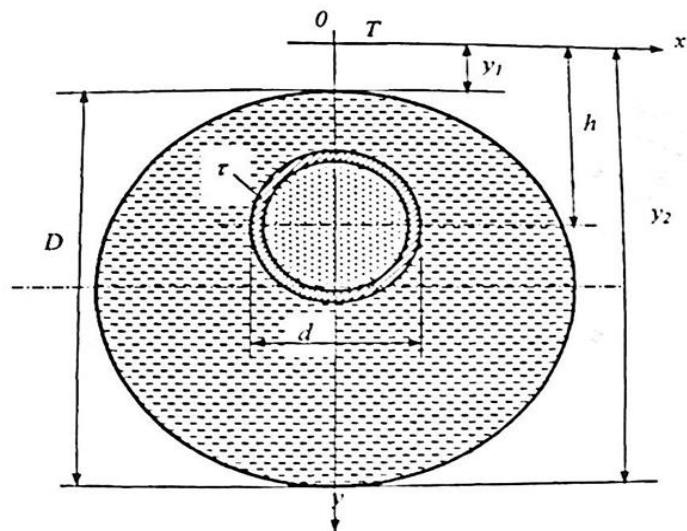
Схема ореола оттаивания мерзлого грунта вокруг «теплого» газопровода
